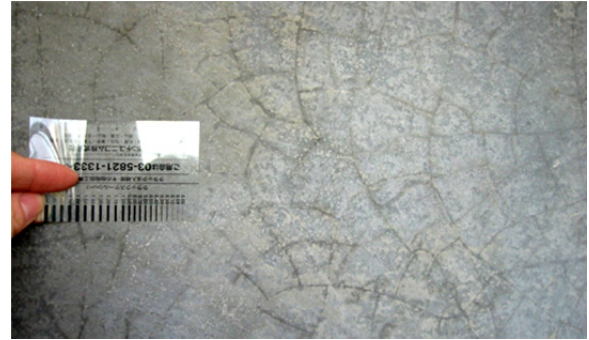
軽量コンクリート製PCCW表面のひび割れ
